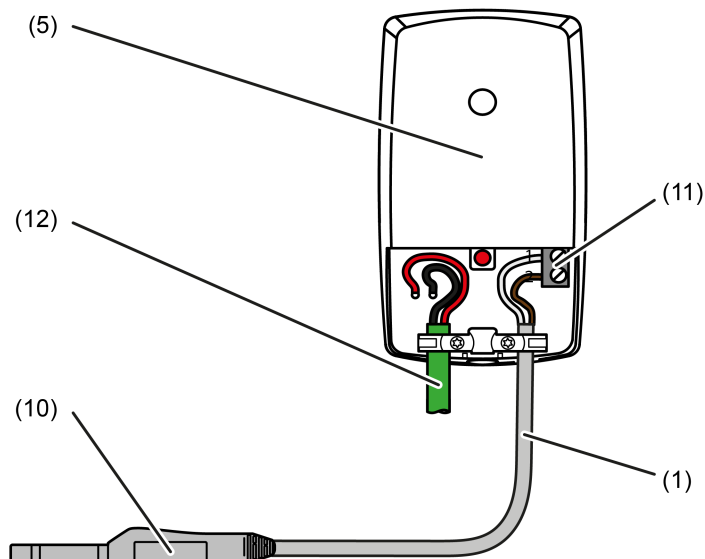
Anschluss des Leckagesensors an den KNX Motor-Ventilantrieb mit Regler
